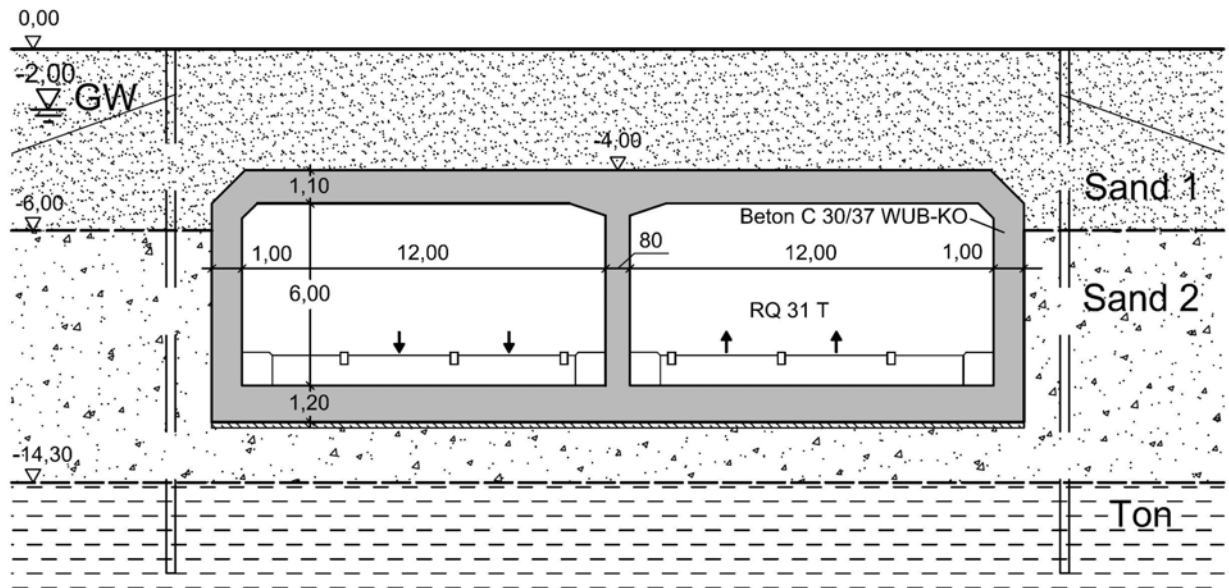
Tunnel in offener Bauweise, Querschnitt Endzustand
